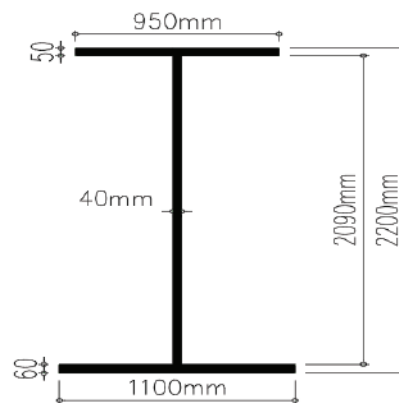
Prédimensionnement de la poutre principale de la variante bipoutre.
